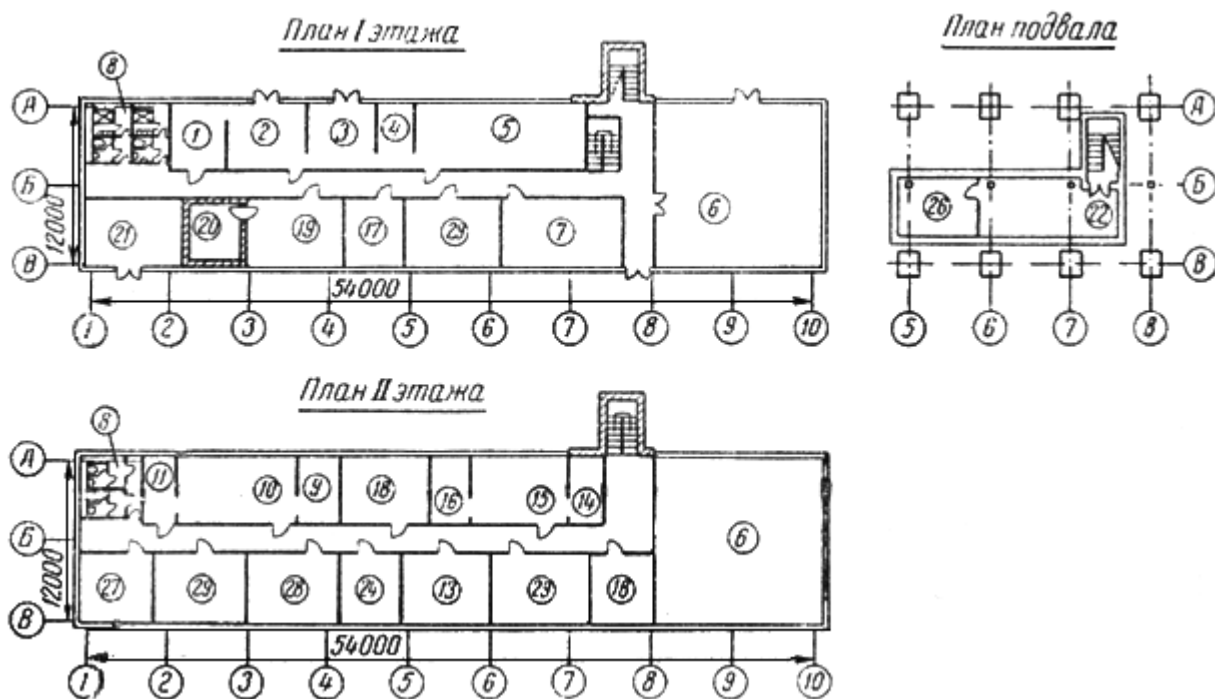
Схематический план помещений лаборатории типа II-Р для строительства гидроузлов с объемом бетонных работ до 1 млн. м³ в отдаленных от крупных центров местностях
